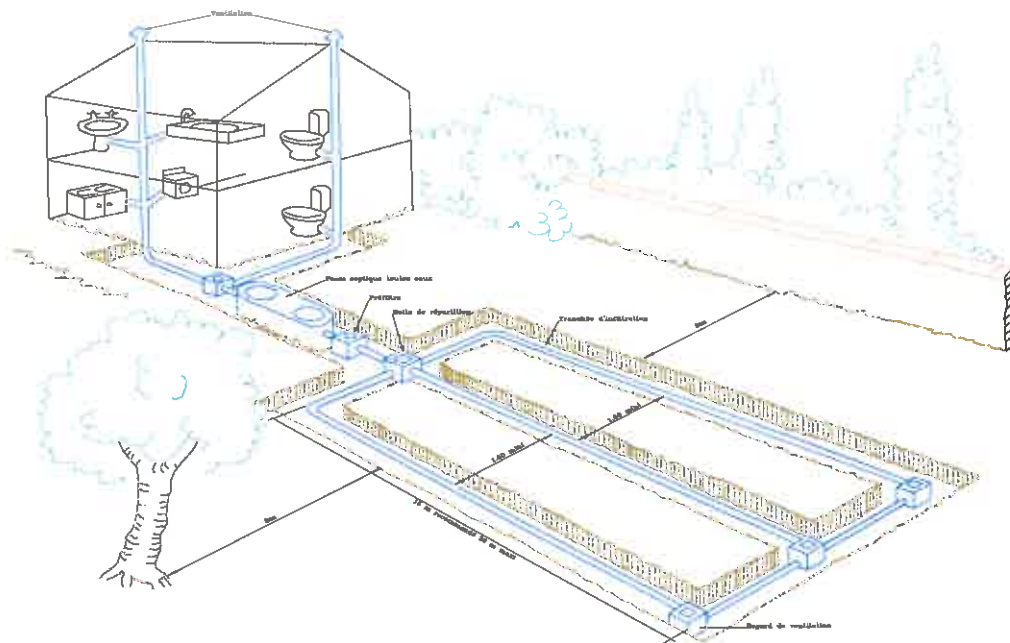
b : exemple d'une filière d'assainissement autonome avec filtre vertical drainé
